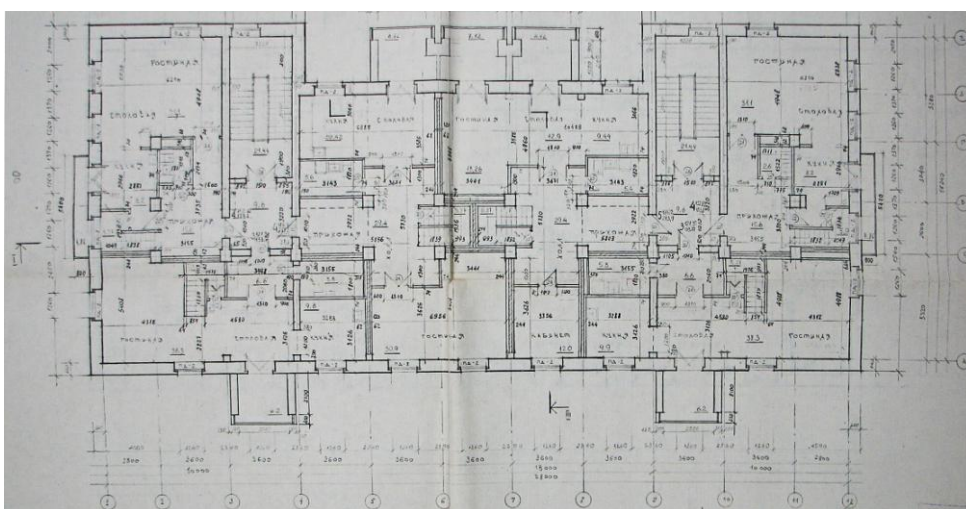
Жилой дом по пр. Мира, д. 122Б. План 5 этажа.
